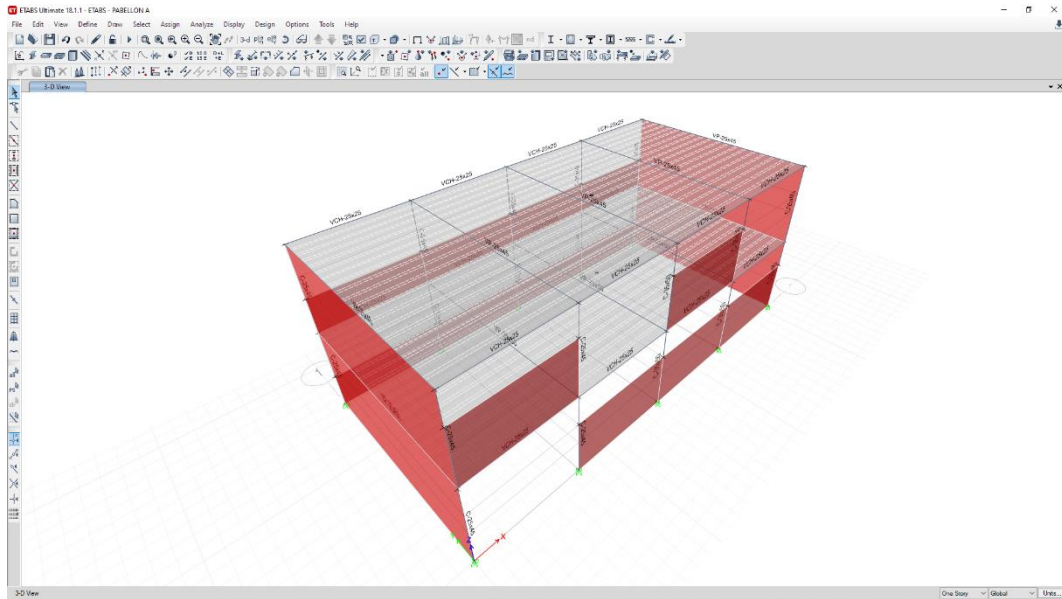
Modelo desarrollado en Etabs 16.0.2 – Pabellón A.
